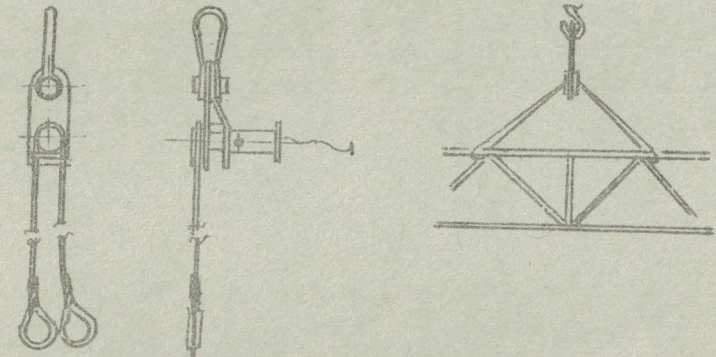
Строповка ферм стропами с полуавтоматическим замком
